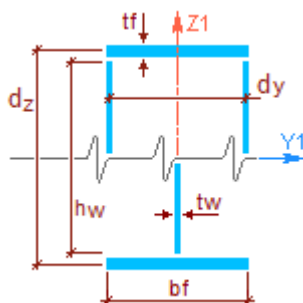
Схема профиля Двутавр сварной симметричный / Коробка сварная симметричная
